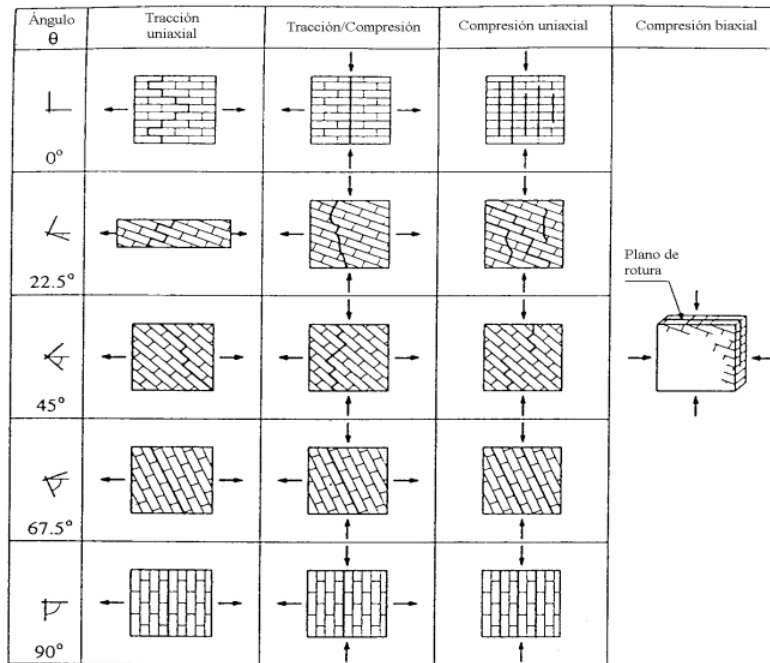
Mecanismos de fisuración en la mampostería.
